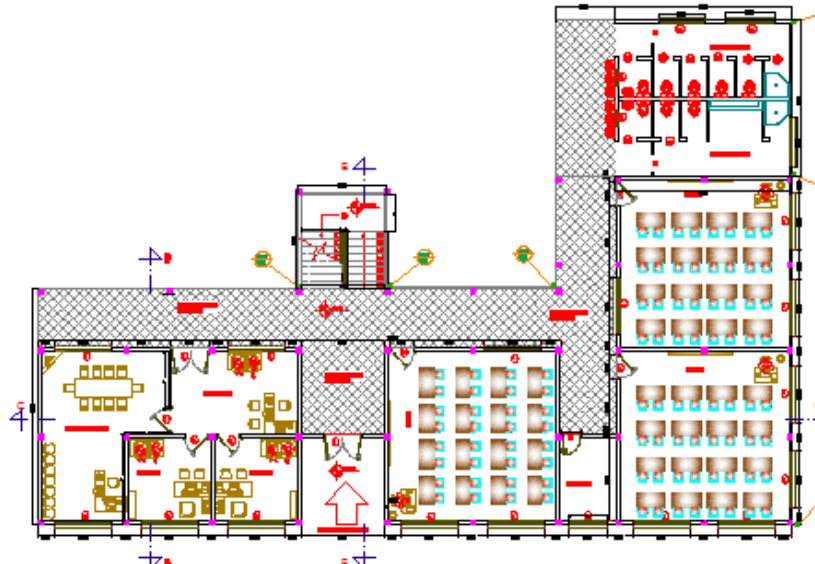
Vista del Plano arquitectónico Planta Baja Aulas
